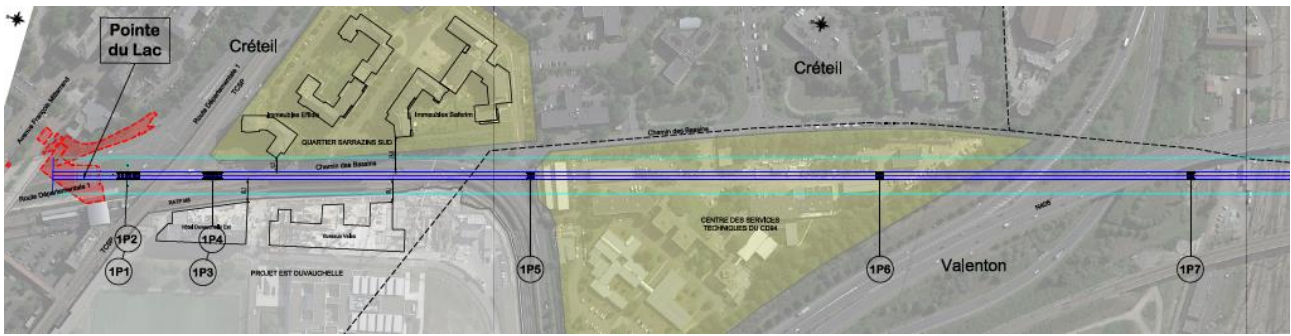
VUE EN PLAN DU TRACE POINTE DU LAC – TEMPS DURABLES
